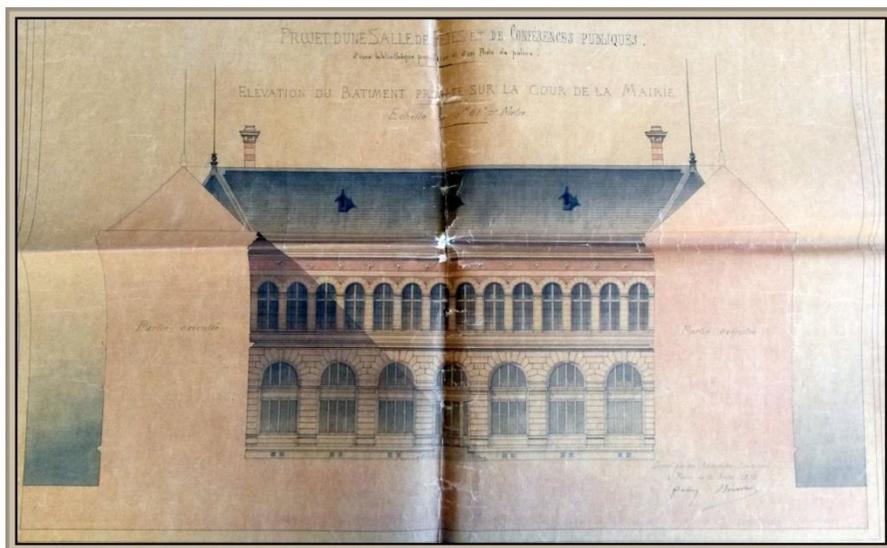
J. Bourdais, G. Davioud, *Élévation du bâtiment présenté sur la cour de la mairie*, 8 avril 1878
